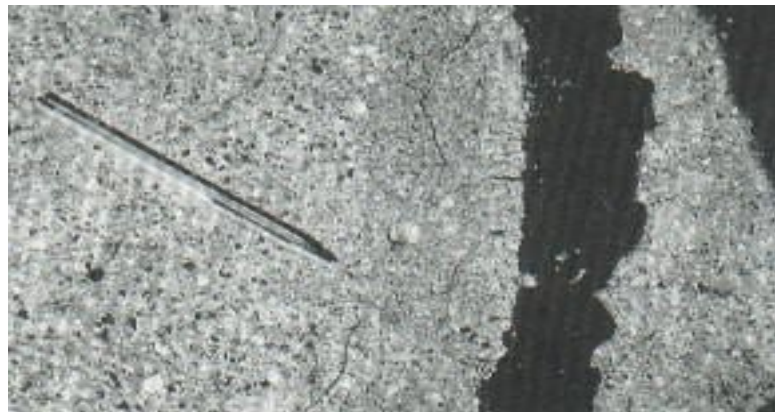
Grieta de durabilidad D baja severidad.
